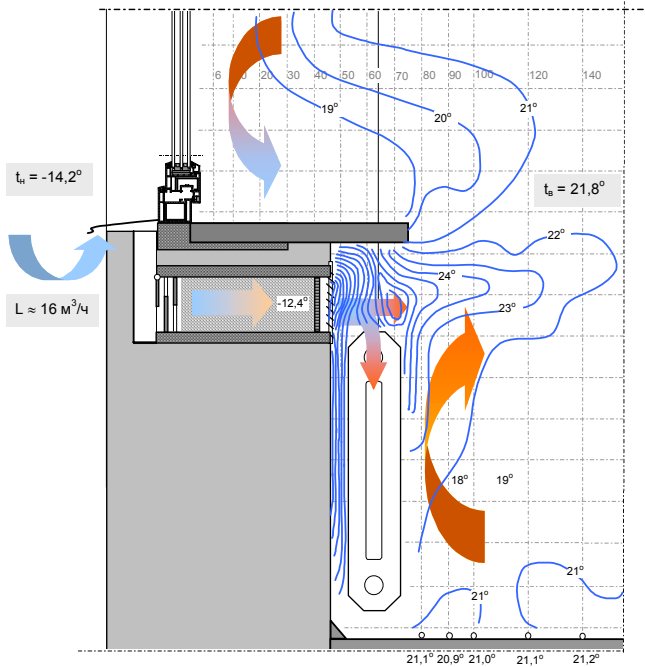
Схема установки стенового вентиляционного клапана «СВК В-75» в наружной стене
